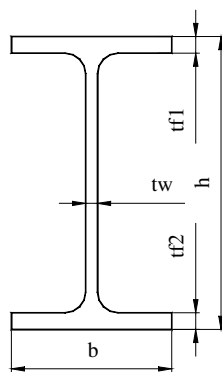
Controlo dimensional em cinco zonas da secção recta da viga.
